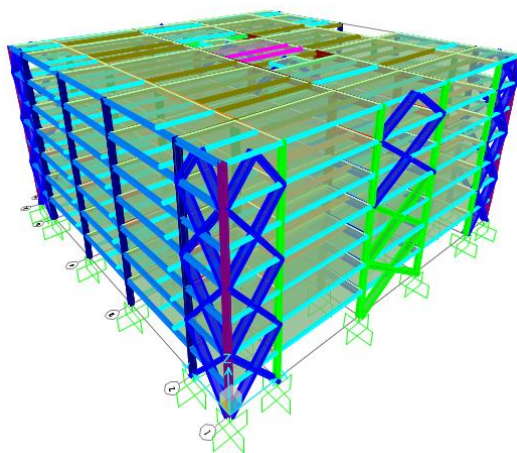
Vista 3D de modelo estructural de Edificio#4. Fuente: [6]
